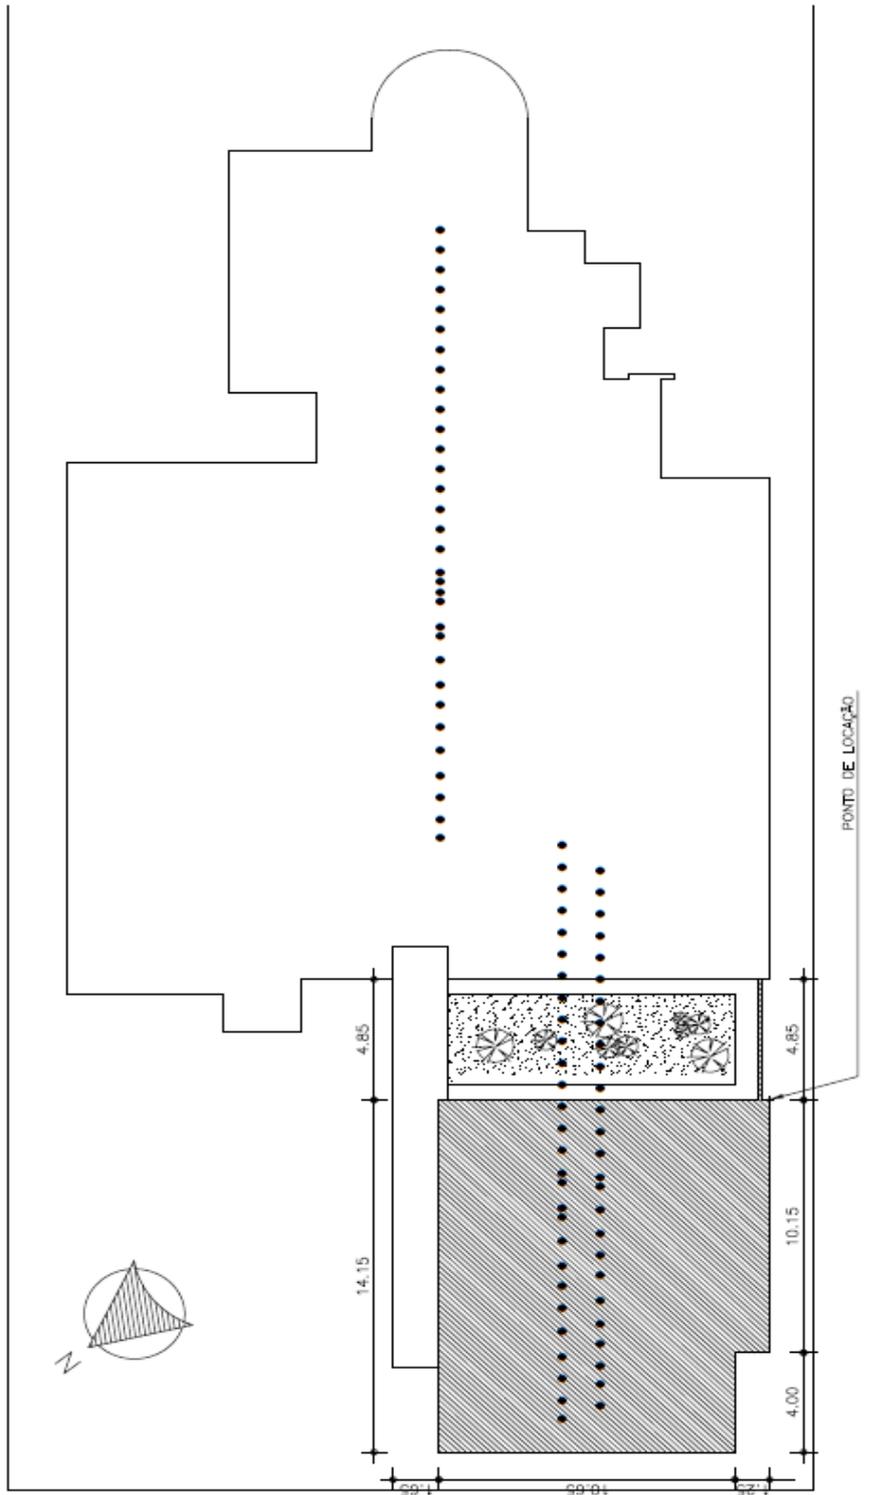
Planta de situação do projeto final do estudo de caso. (Fonte: COP/UFC)
